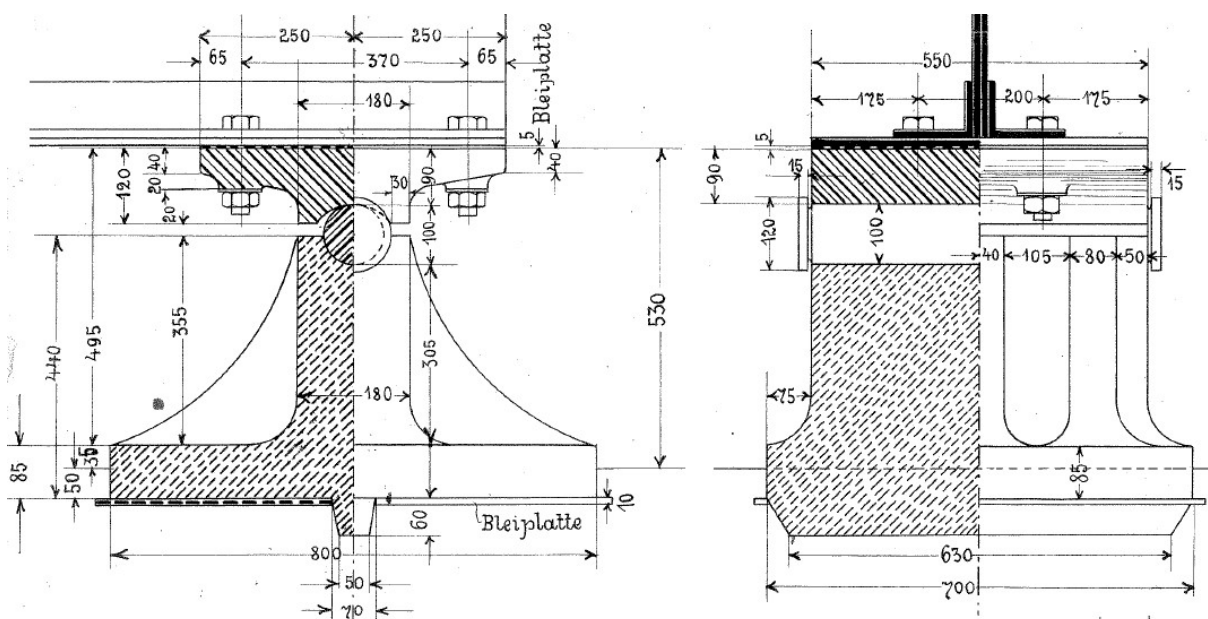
Geometrie opěr a středního pilíře, upraveno [3]
